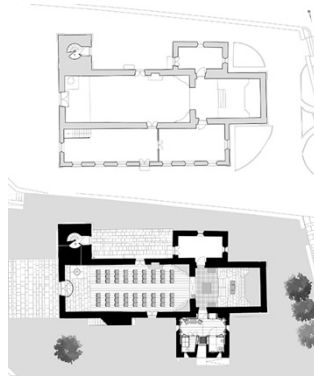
Planta piso 0 da Igreja de Gilmonde. Levantamento, em cima, e projeto, em baixo. Imagem do autor.
